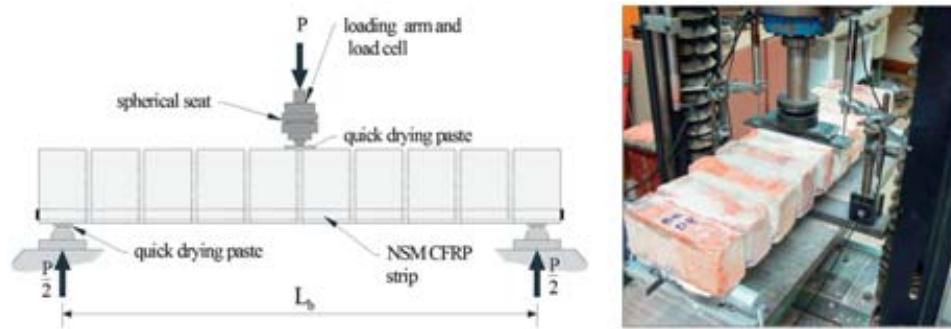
Montaje de la viga de mampostería (Izq.) y espécimen durante la prueba (Der.)
